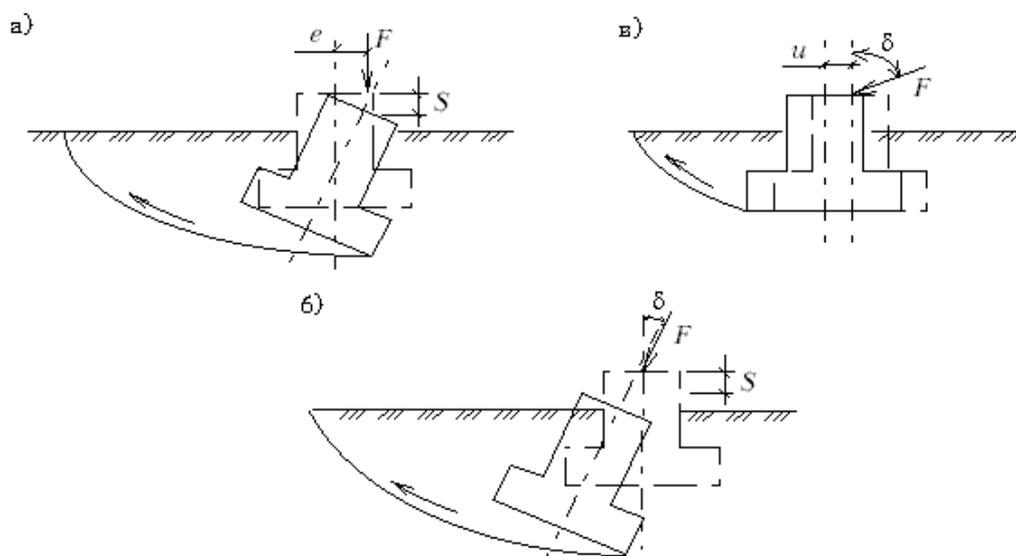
Возможные схемы потери устойчивости основанием: а – осадка фундамента с поворотом; б – осадка фундамента с поворотом и смещением; в – сдвиг фундамента по подошве
